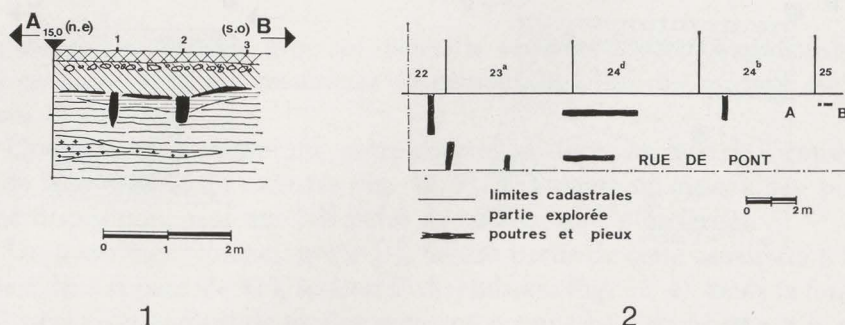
Rue de Pont. 1: section C, parcelle 25, profil à la cote 15; 2: assemblage de poutres provenant d'un bâtiment en bois.
